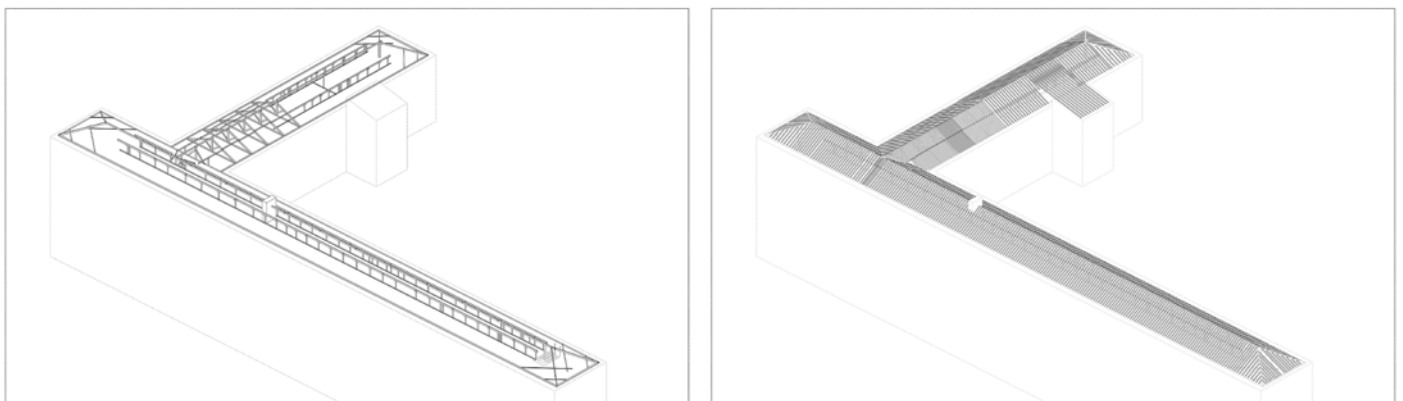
Levantamiento de los elementos de estructura de cubierta, armaduras (izquierda) y colocación de los pares (derecha). Fuente: Elaboración propia.
